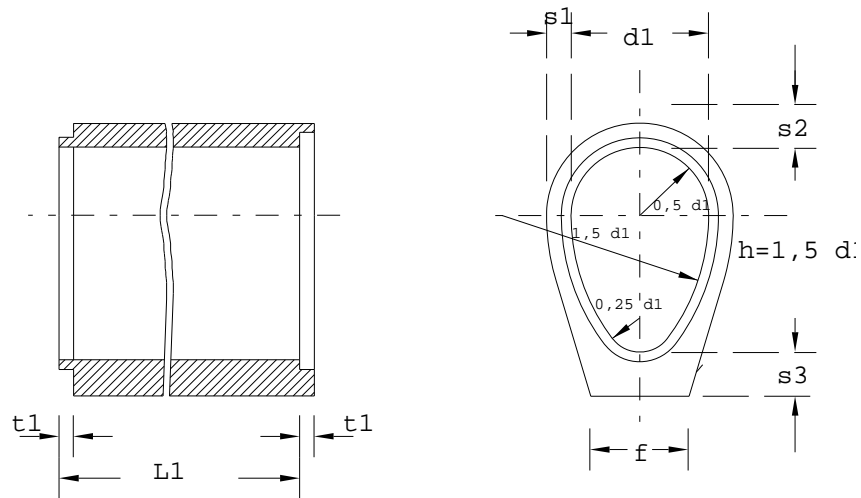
tubo in calcestruzzo di sezione ovoidale con giunto a risega e con piede di appoggio
